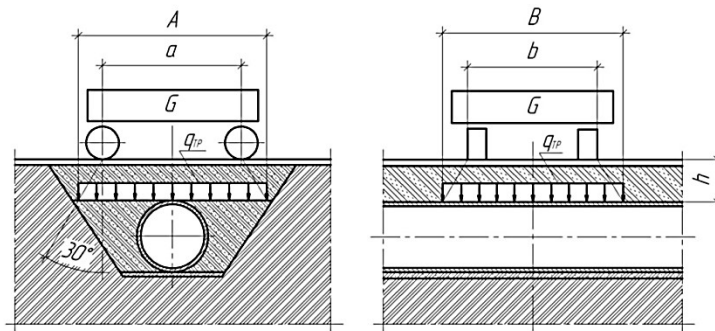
Схема навантаження трубопроводу транспортом
